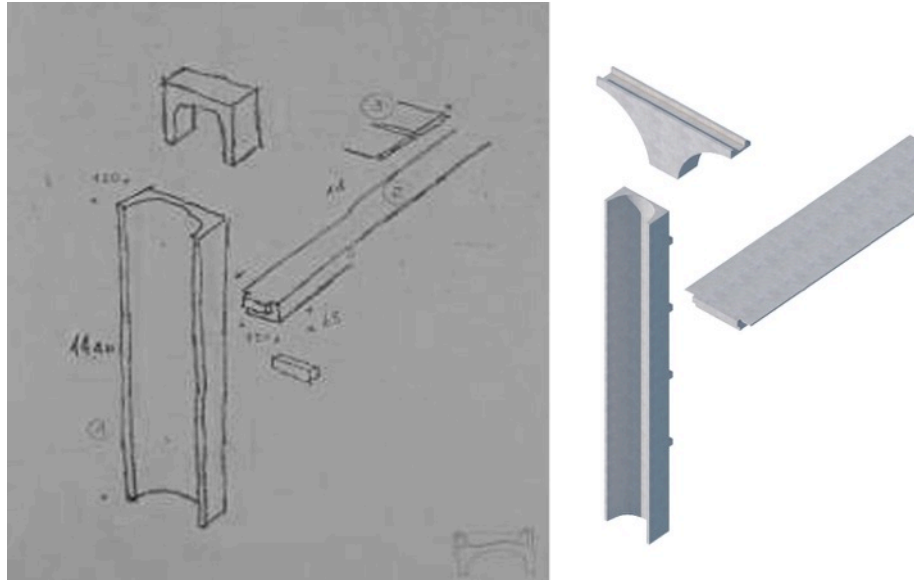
As três peças básicas. Comparativo entre o Croqui de Niemeyer e o Modelo Virtual, conforme edificação construída. Fonte: Fundação Niemeyer e Acervo do Autor.
